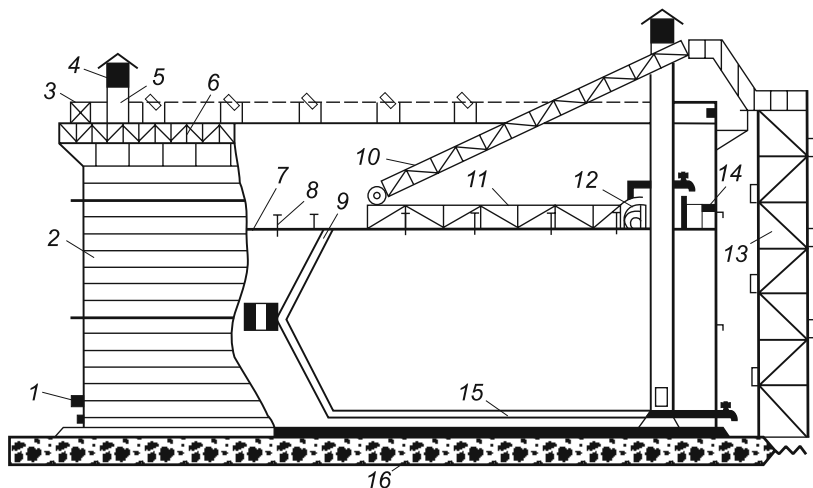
Резервуар с плавающей крышей: 1 — приемно-раздаточный патрубков; 2 — стенка резервуара; 3 — трубопровод раствора пены; 4 — огнепреградитель; 5 — трубчатая направляющая; 6 — сухопровод орошения; 7 — плавающая крыша; 8 — опорные стойки крыши; 9 — водоприемник атмосферных осадков; 10 — лестница на катках; 11 — опорная ферма; 12 — газоотводящая труба; 13 — шахтная лестница; 14 — уплотняющий запор; 15 — дренажная система; 16 — фундамент
